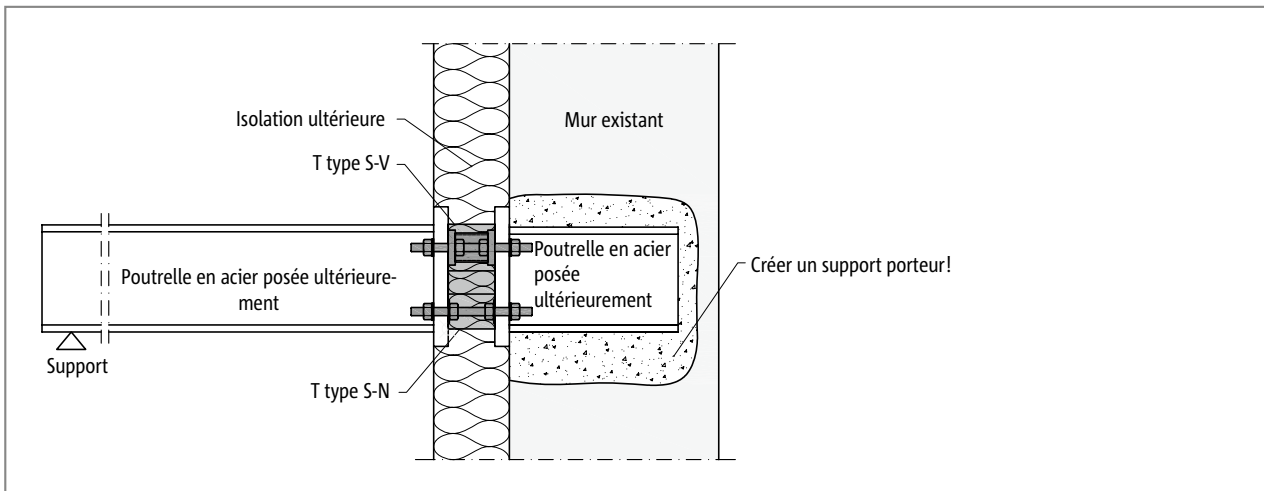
Schöck Isokorb® T type S-N et T type S-V : balcon en acier soutenu posé ultérieurement ; raccordé à un support mural posé ultérieurement
